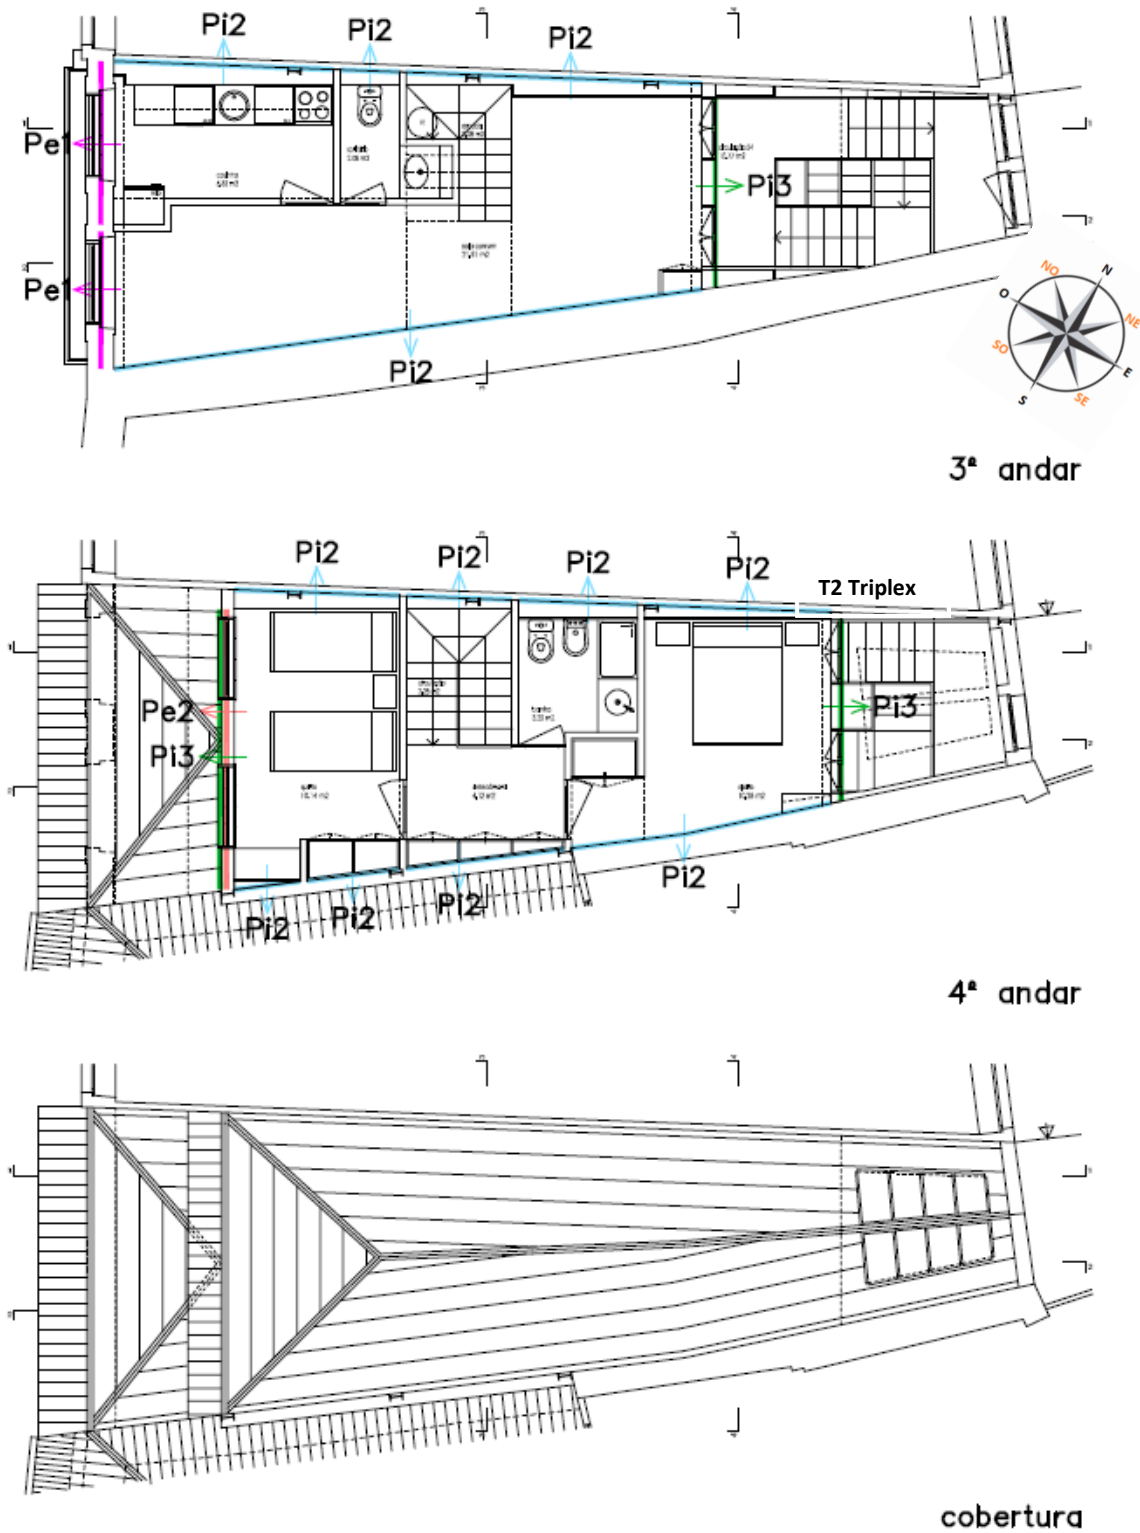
Planta do 3º piso, 4º piso e cobertura [19]
